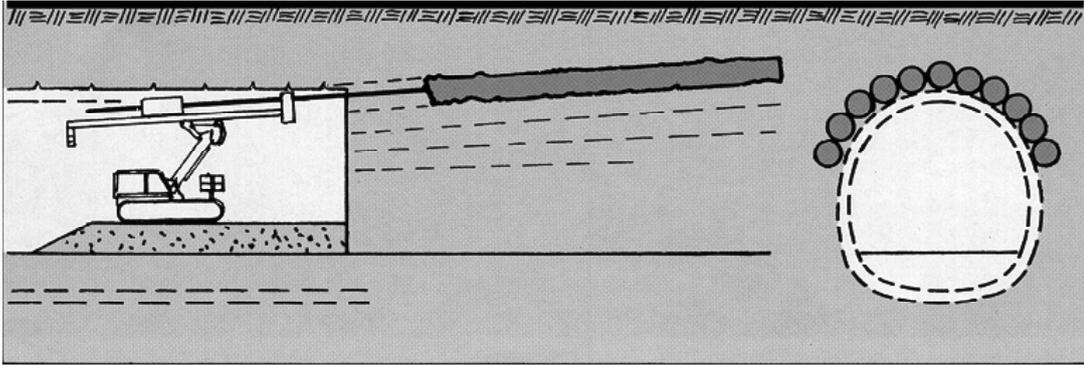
Anwendungsgebiete des HDI-Verfahrens: Schirminjektion im Tunnelbau
